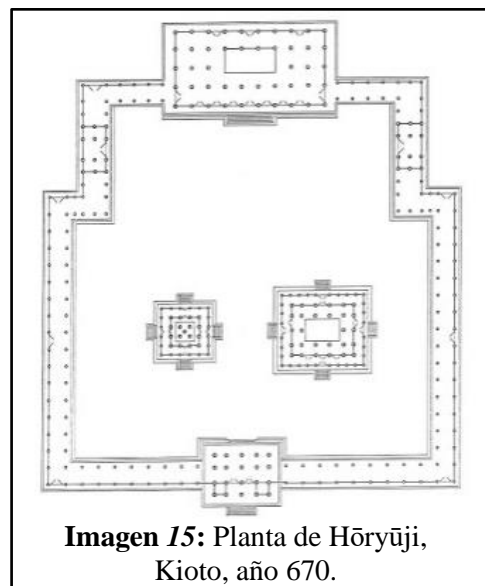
Planta de Hōryūji, Kioto, año 670.
